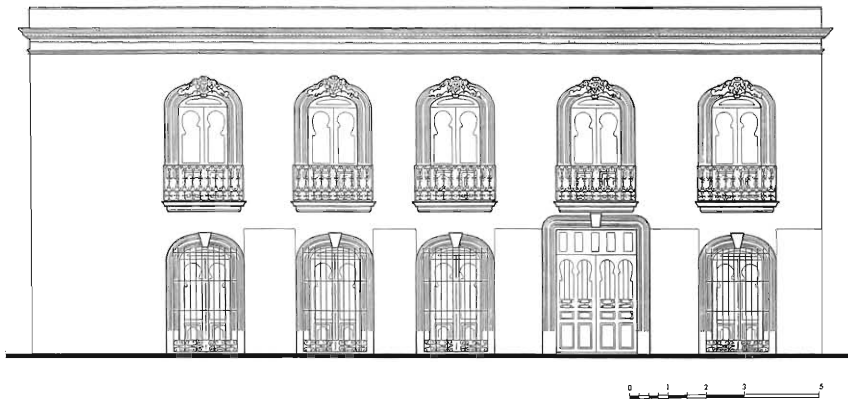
GUERRERO ESQ. ARMENTA Y LÓPEZ. FACHADA LATERAL.
